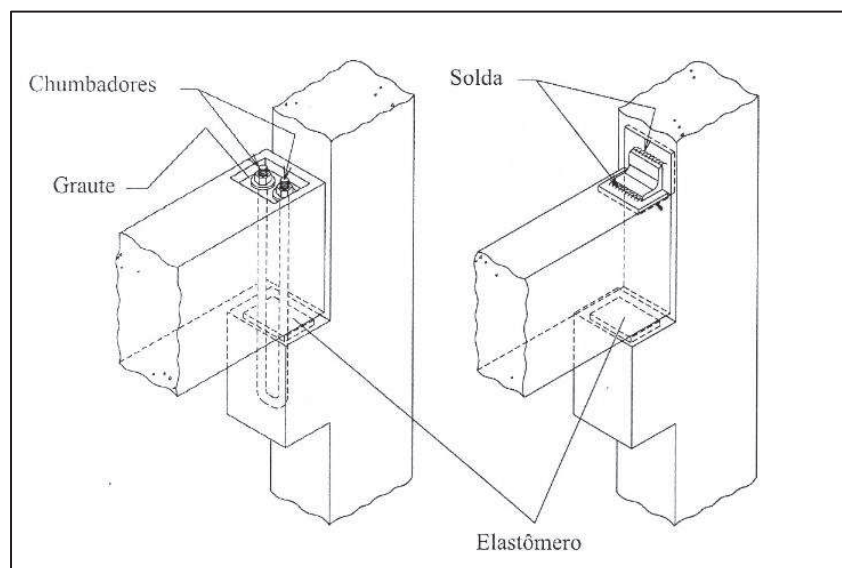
Exemplo Ligação Rotulada em vigas pré-fabricadas.
